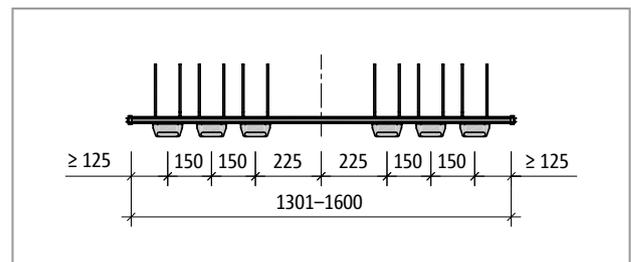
Schöck Tronsole® Typ T-V6-...-L1301 bis L1600: Produktgrundriss
